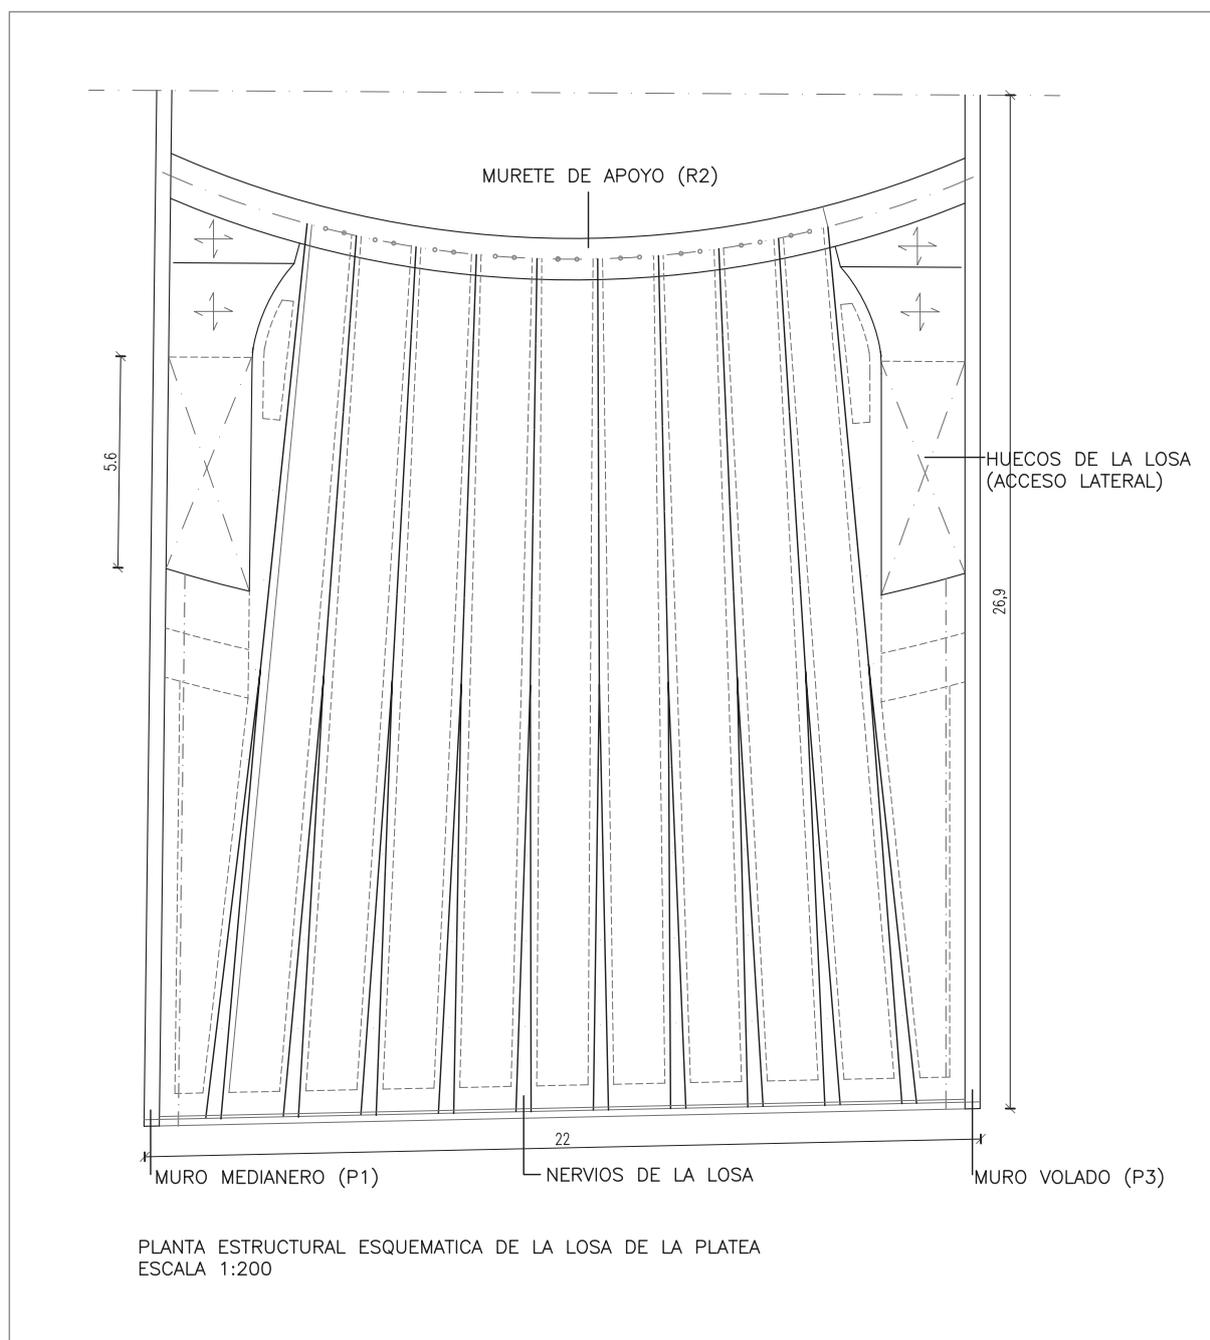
Planta esquemática de la losa de la platea 1:200 [27]
